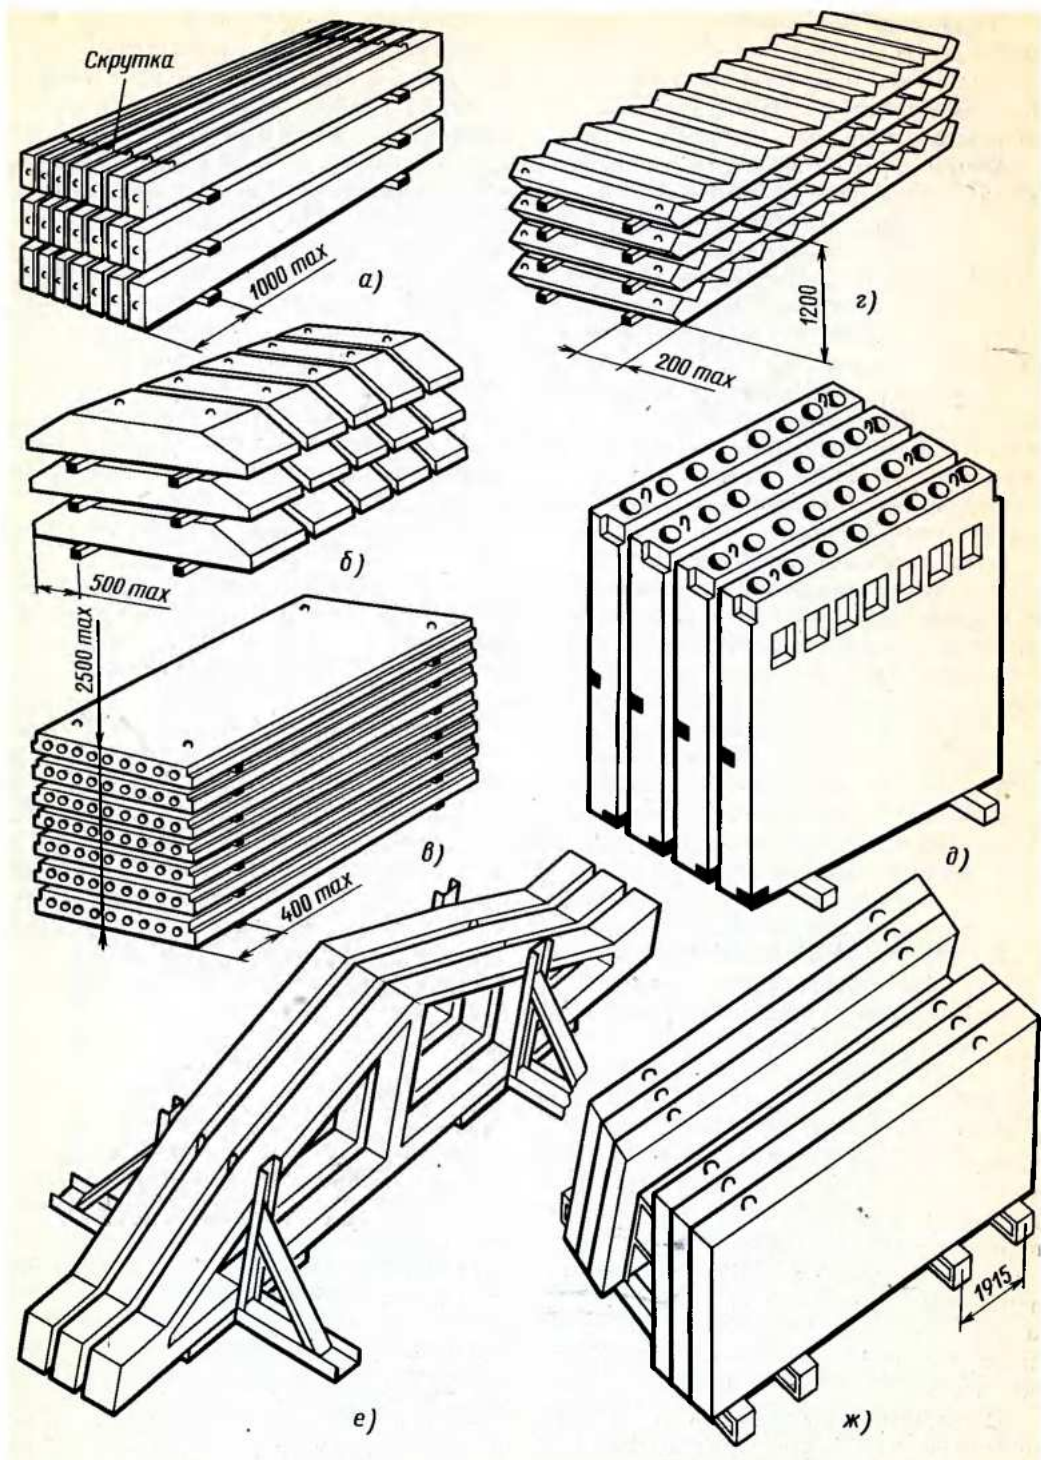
Укладка грузов в штабель на ребро, плашмя, в вертикальном положении:
